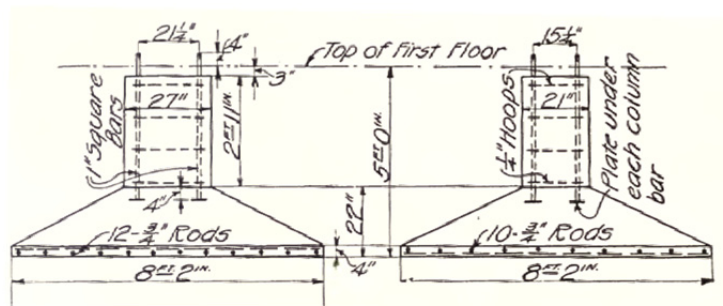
Zapatas aisladas trapezoidales de hormigón armado. Eddy et al. [6].
